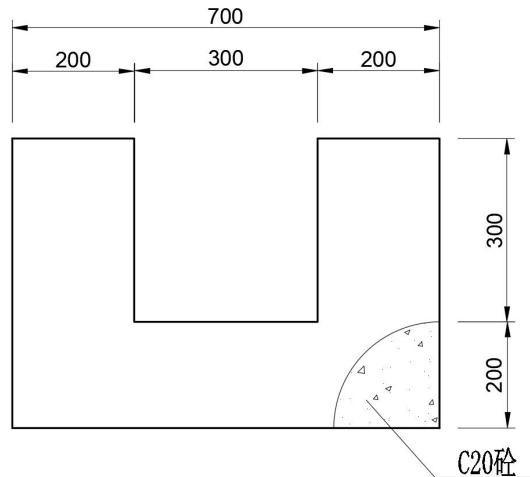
HP02 截排水沟设计断面图（单位 mm）
